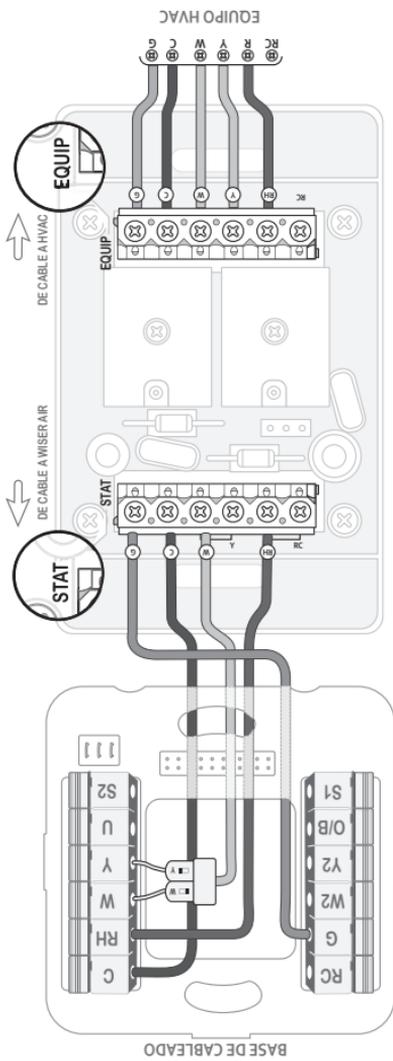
Instalación del PCB en un sistema de 5 cables.
